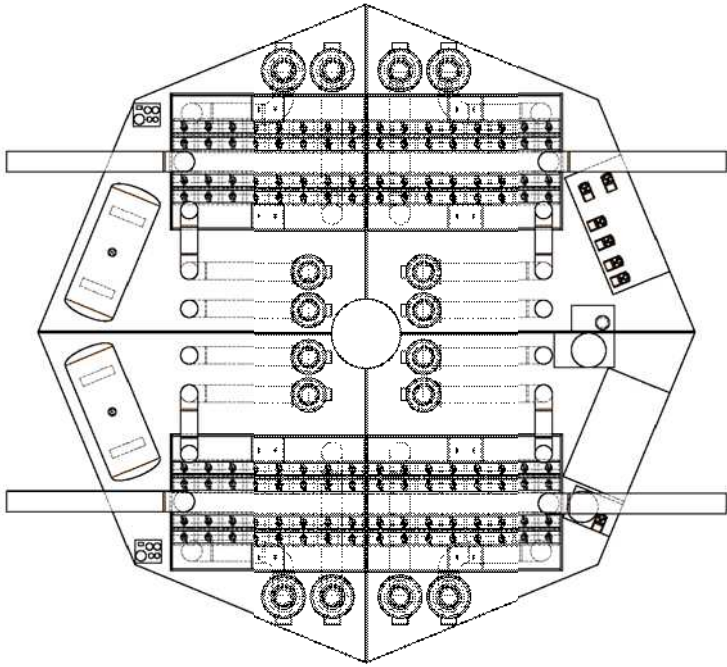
概略配置图 (10MW 1 階部 平面图·立面图)
